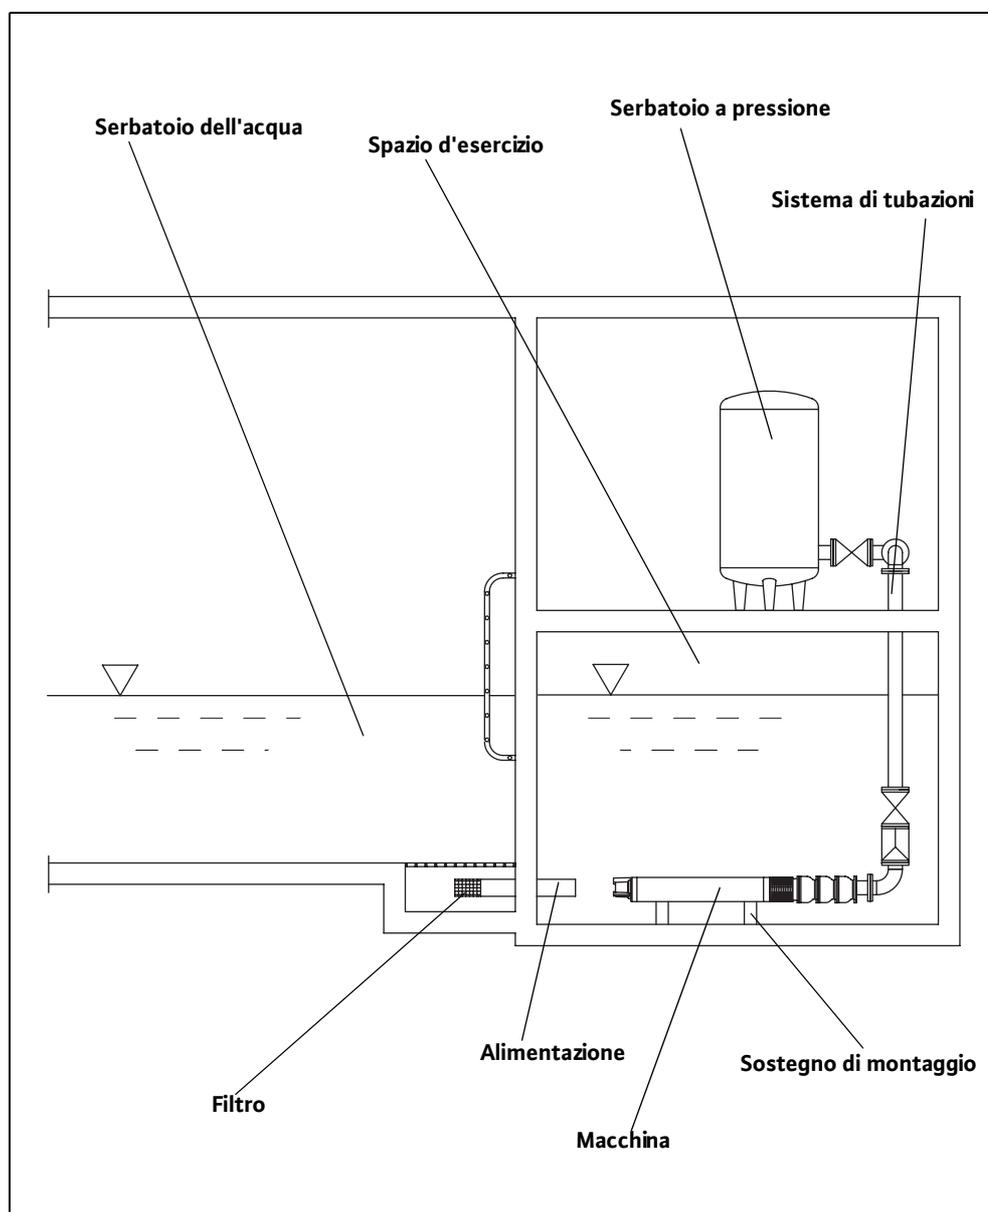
Montaggio orizzontale in un impianto di pompaggio
